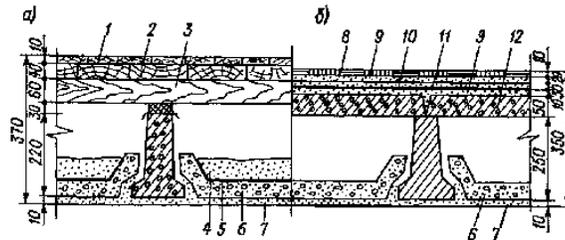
Перекрытие по железобетонным балкам таврового сечения
